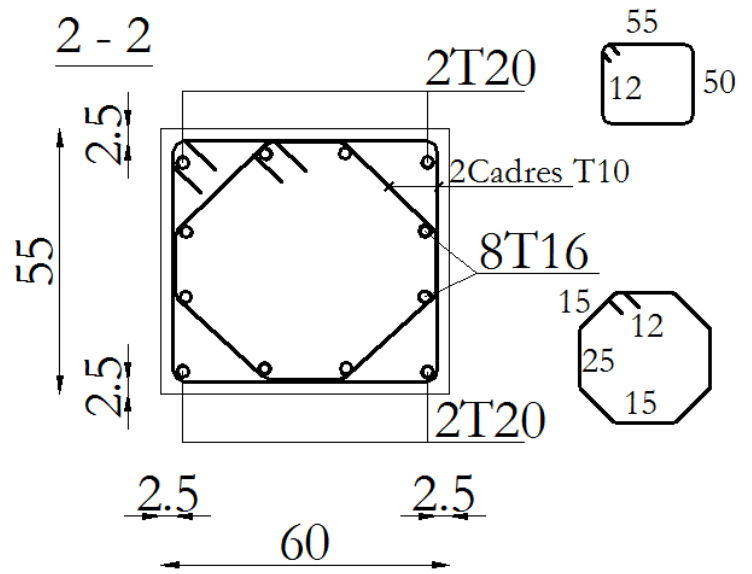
Ferrailage des poteaux RDC et 1<sup>er</sup> étage
